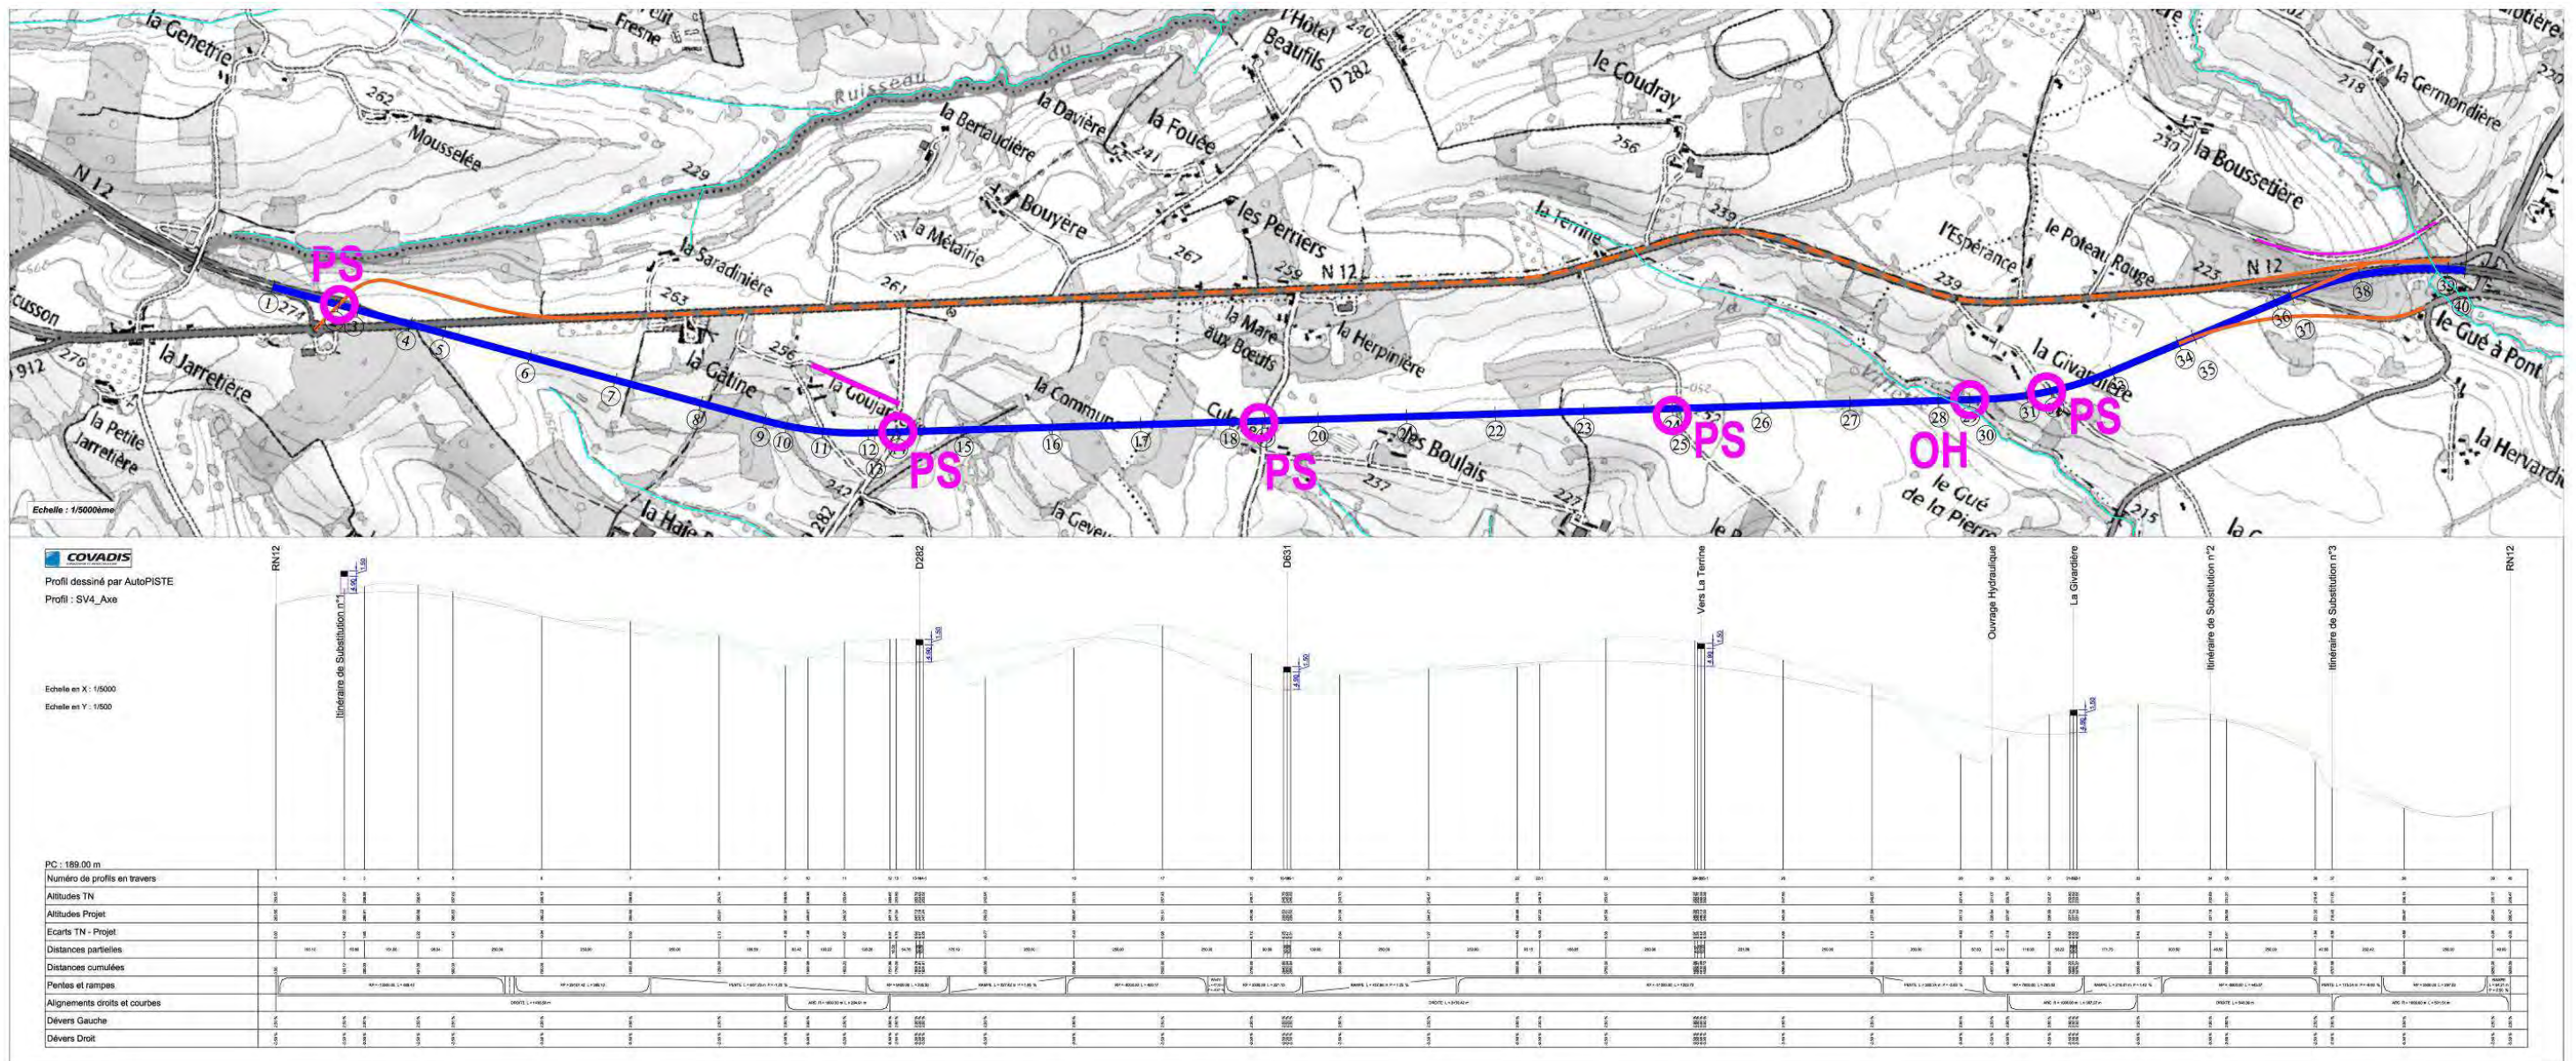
Tracé en plan et profil en long de la variante 4 (source : IGN / SEGIC)
